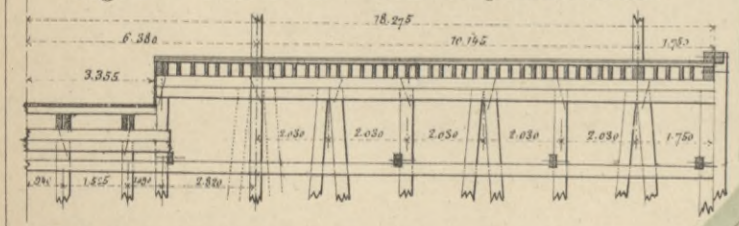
Pier et Hangar N° 4. Demi-coupe transversale.
